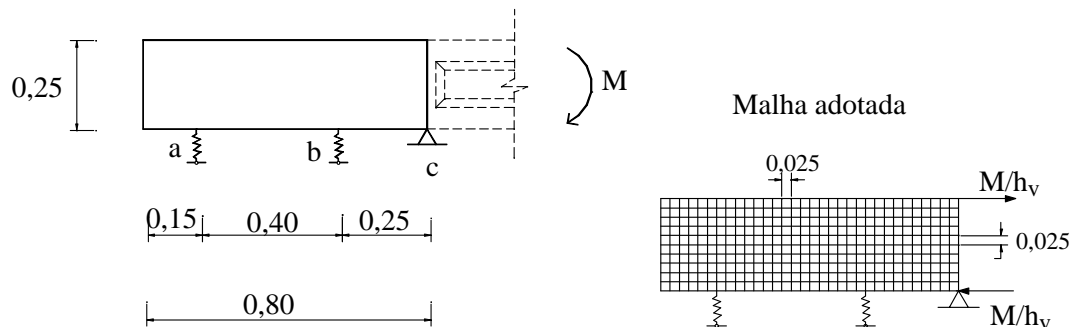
Geometria, dimensões e malha do modelo da viga (dimensões em metros).
